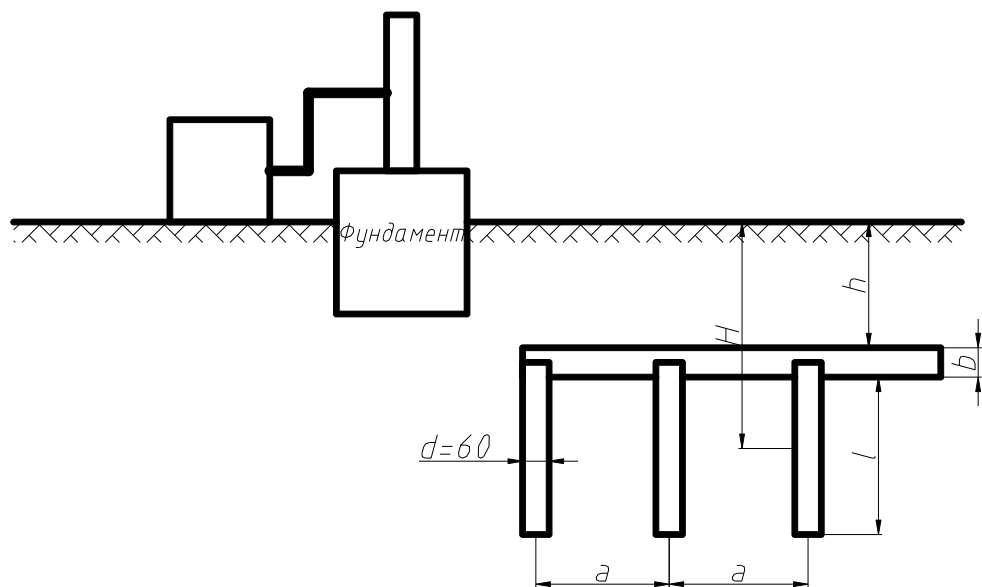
Розрахункова схема заземлення верстату:
